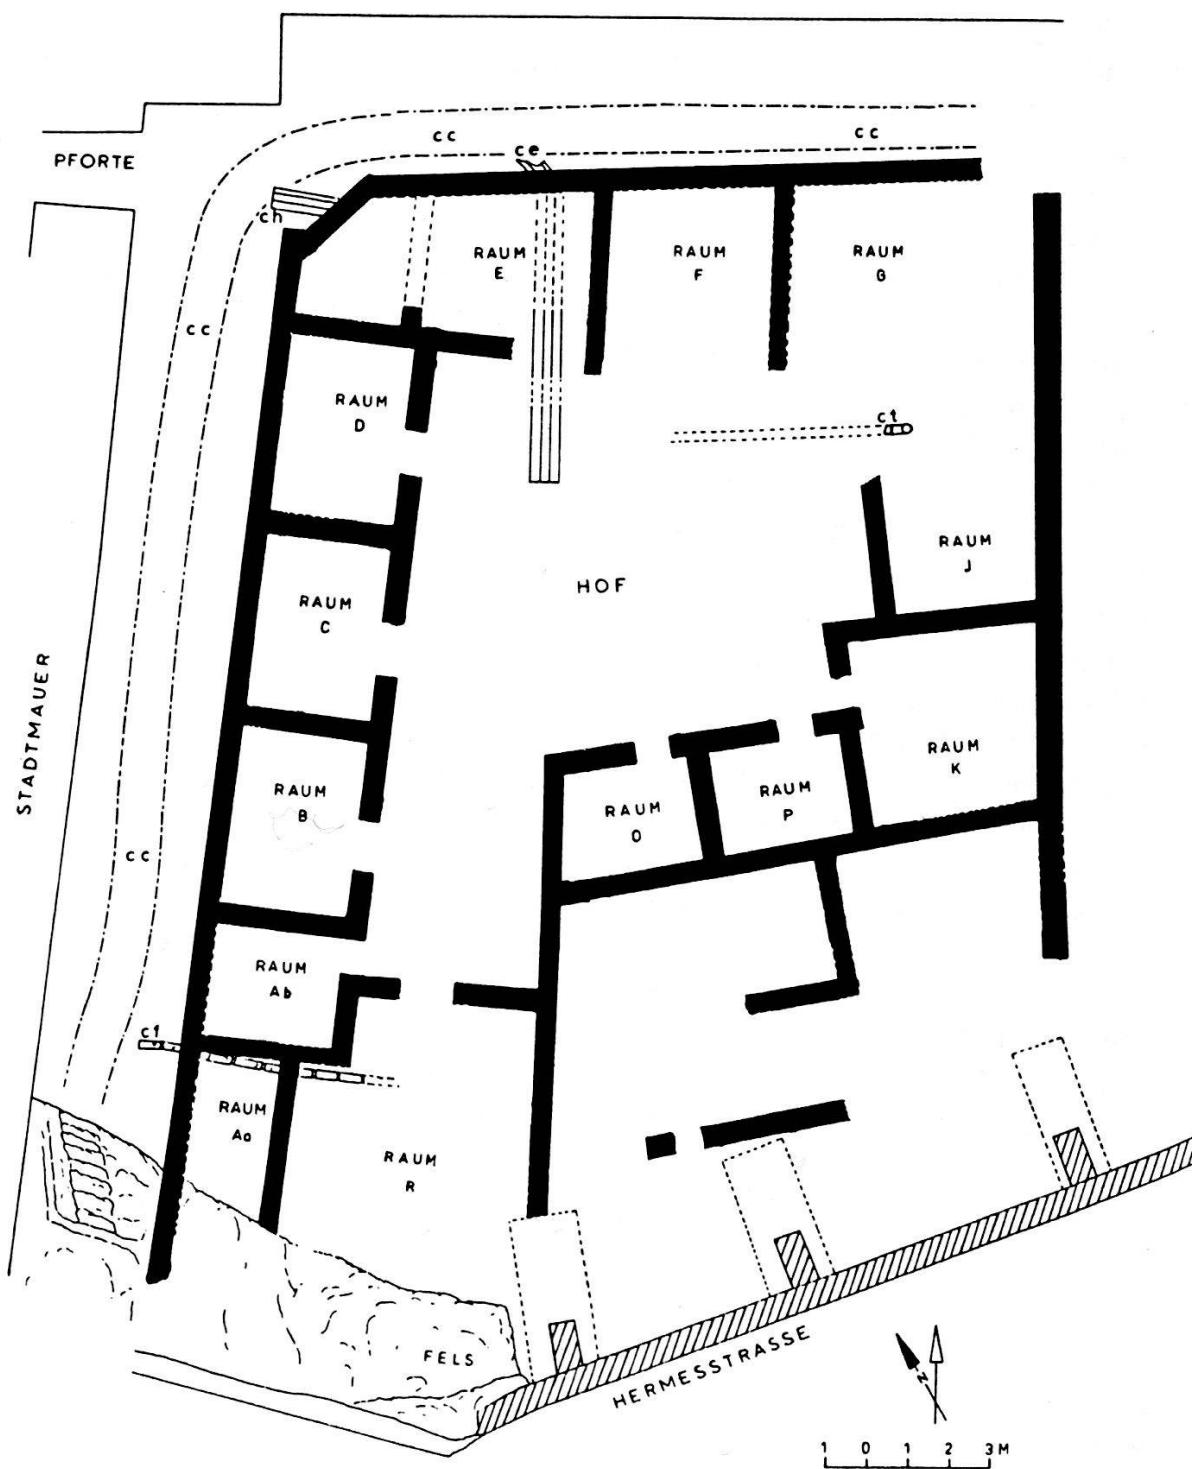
Grundriss des Baues Z 2 (aus: U. Knigge, AA 1981, 390)
